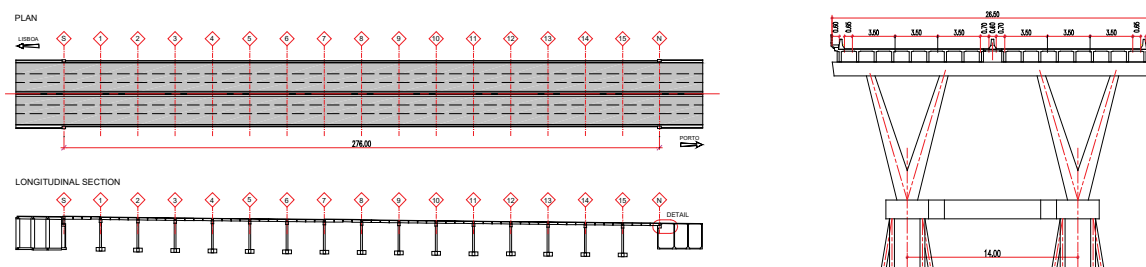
Planta, corte longitudinal e transversal do viaduto
